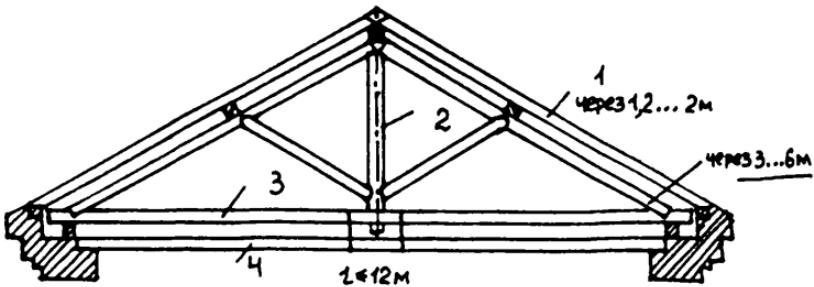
Схема скатной крыши с деревянными комбинированными стропилами:
